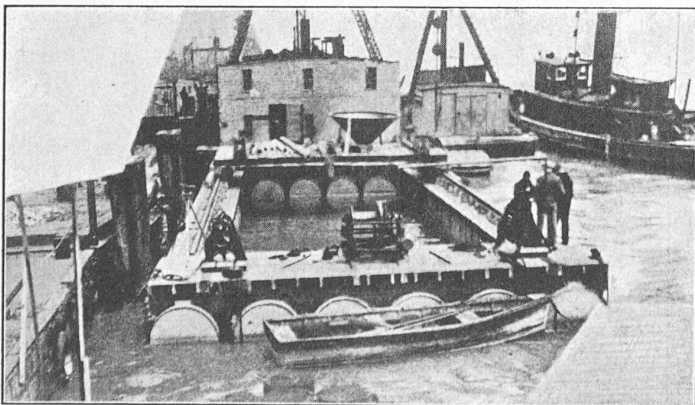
Tunnel à Déroit. — Ponton avec herse.
